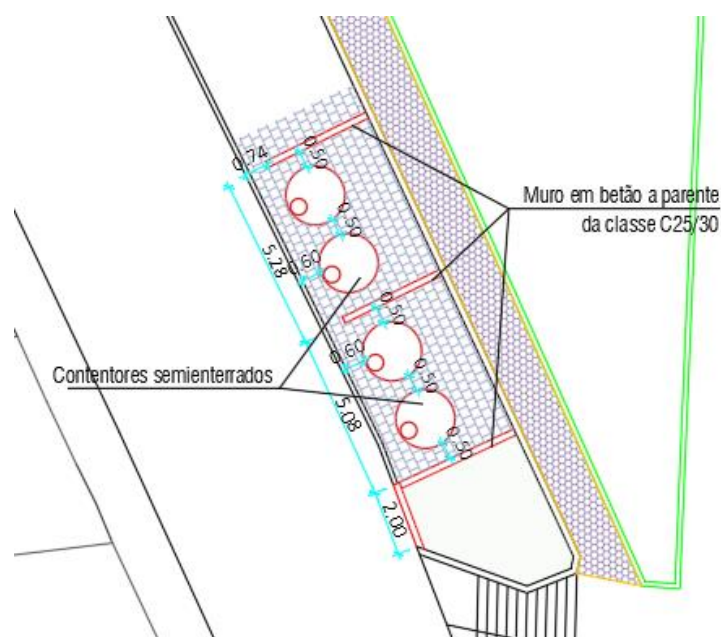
Extrato da planta de construção para a construção na zona de estacionamento.
